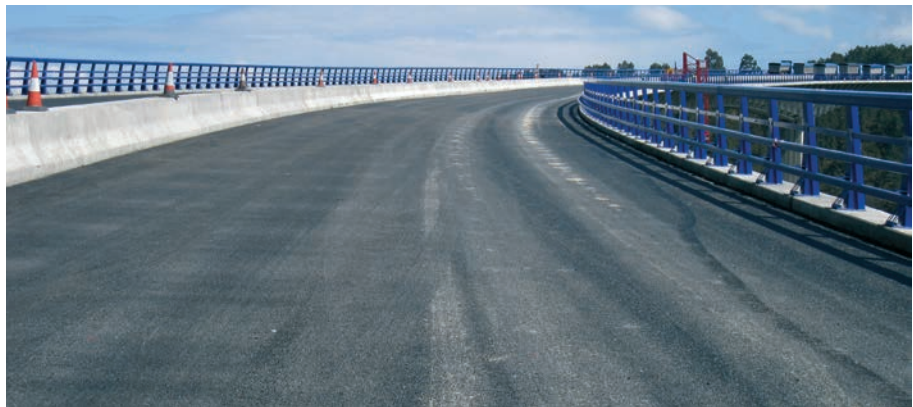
Realización de acabados: pretilas, barrera central y pavimentación
